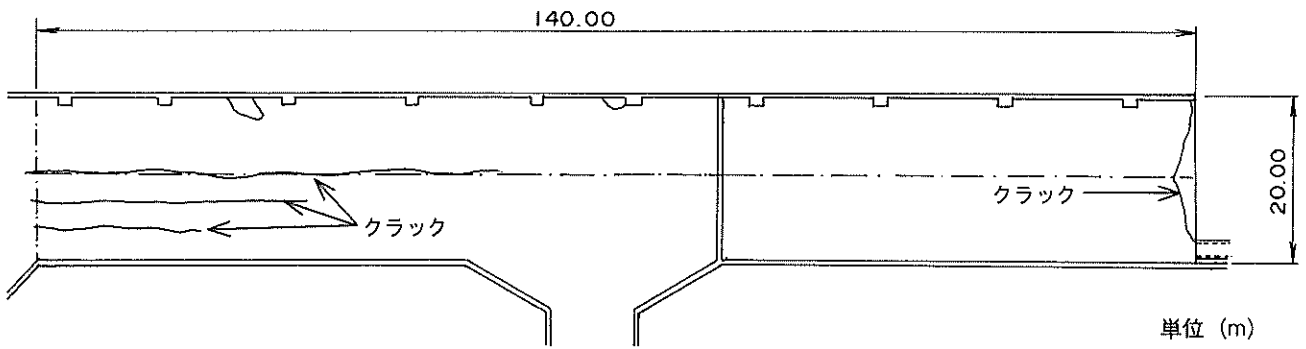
岸壁(-5.0m)(施設番号③)の平面図
